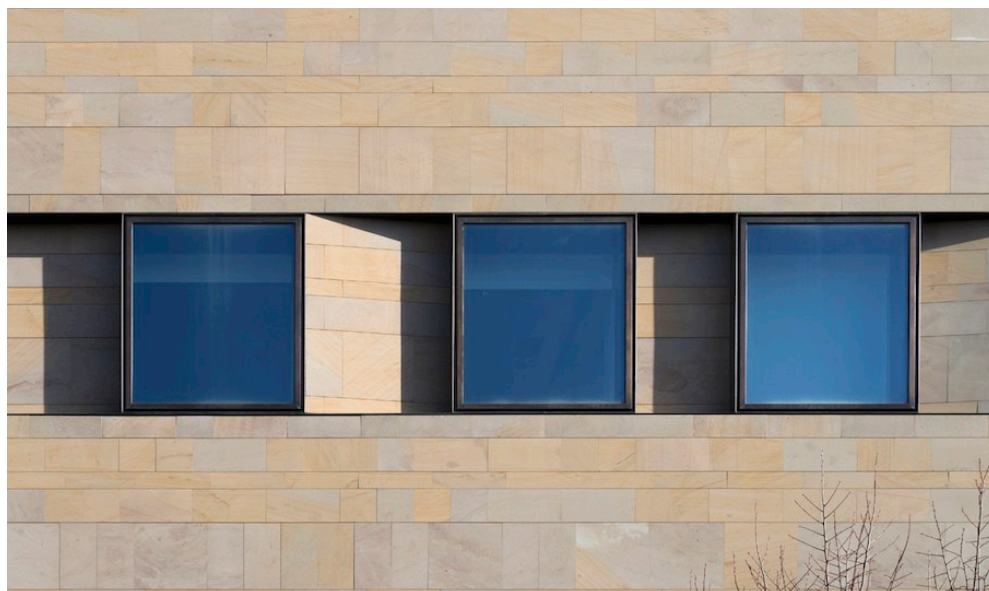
FACHADA EM PEDRA CALCÁRIA
